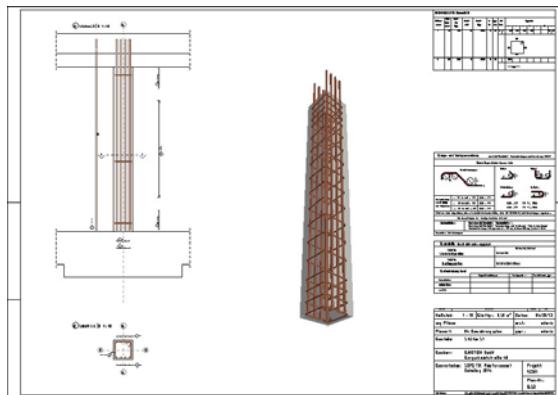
Bewehrungsplan einer Stütze in Revit (mit SOFiSTiK Reinforcement Detailing)
